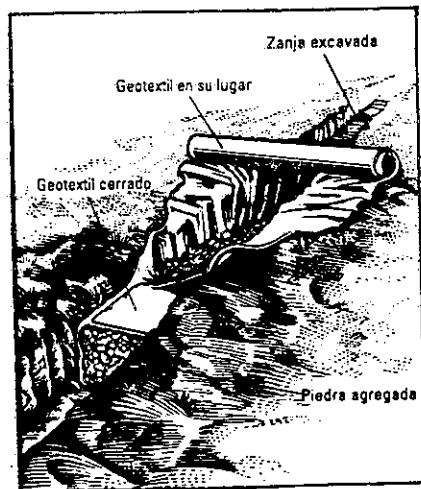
Drenaje adyacente al pavimento (vista isométrica)
